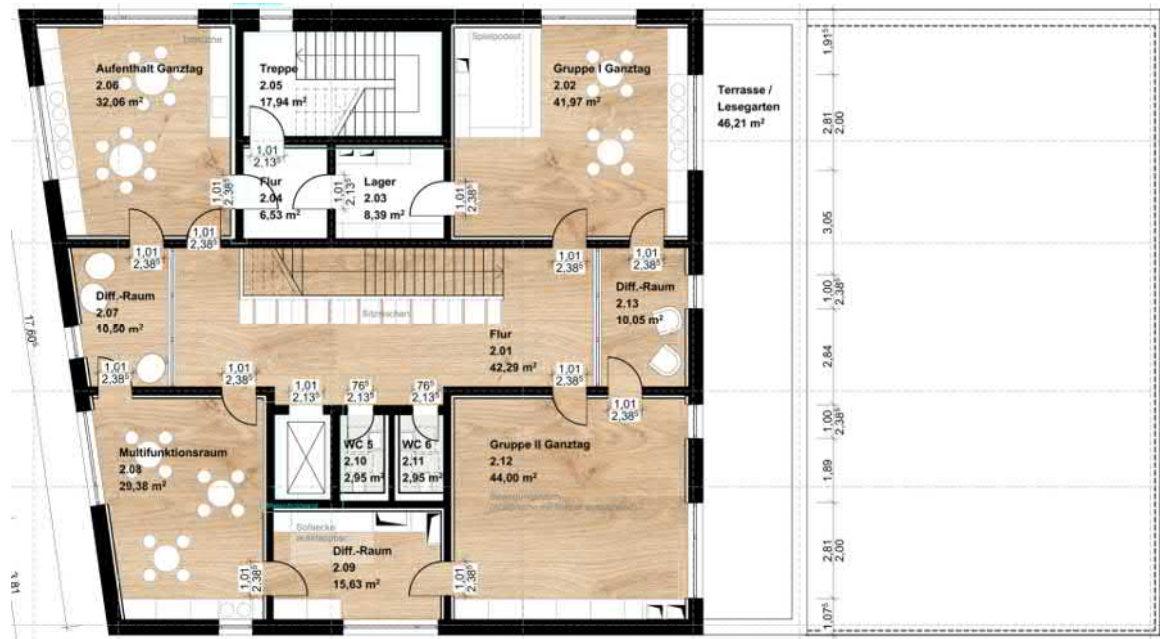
GS Arnum - Neubau Ganztagsgebäude - Grundriss OG
